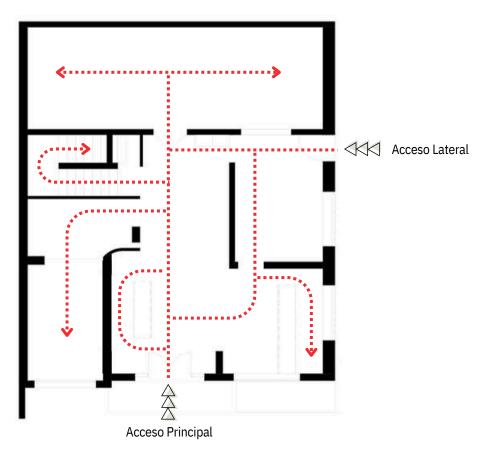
Circulación Actual Planta Baja. Fuente: Elaboración propia.
